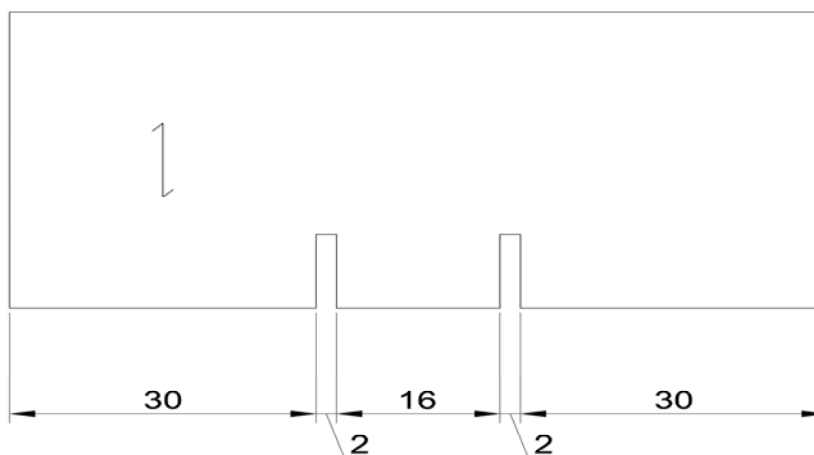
Corpo de prova proposto para o ensaio de cisalhamento paralelo às fibras.
